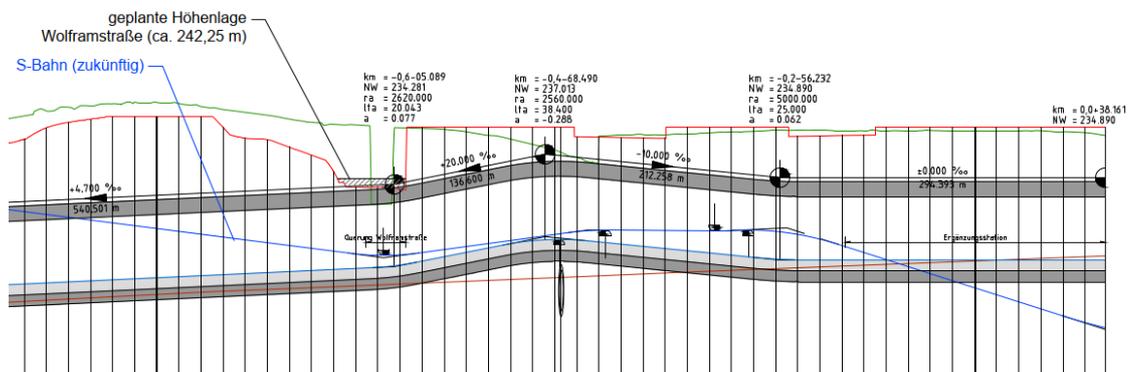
Längsschnitt Bereich Wolframstraße bis Ergänzungsstation Variante 1 (siehe Anlage 2.1)
